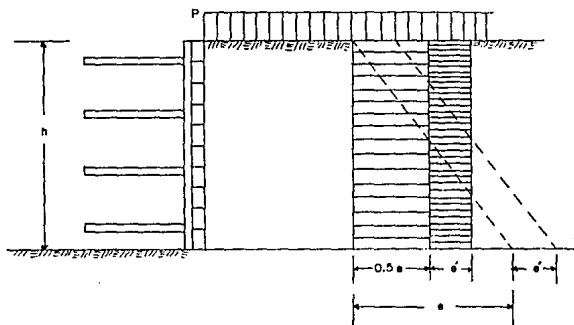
Redistribución de empujes en un ademe con tablas horizontales
